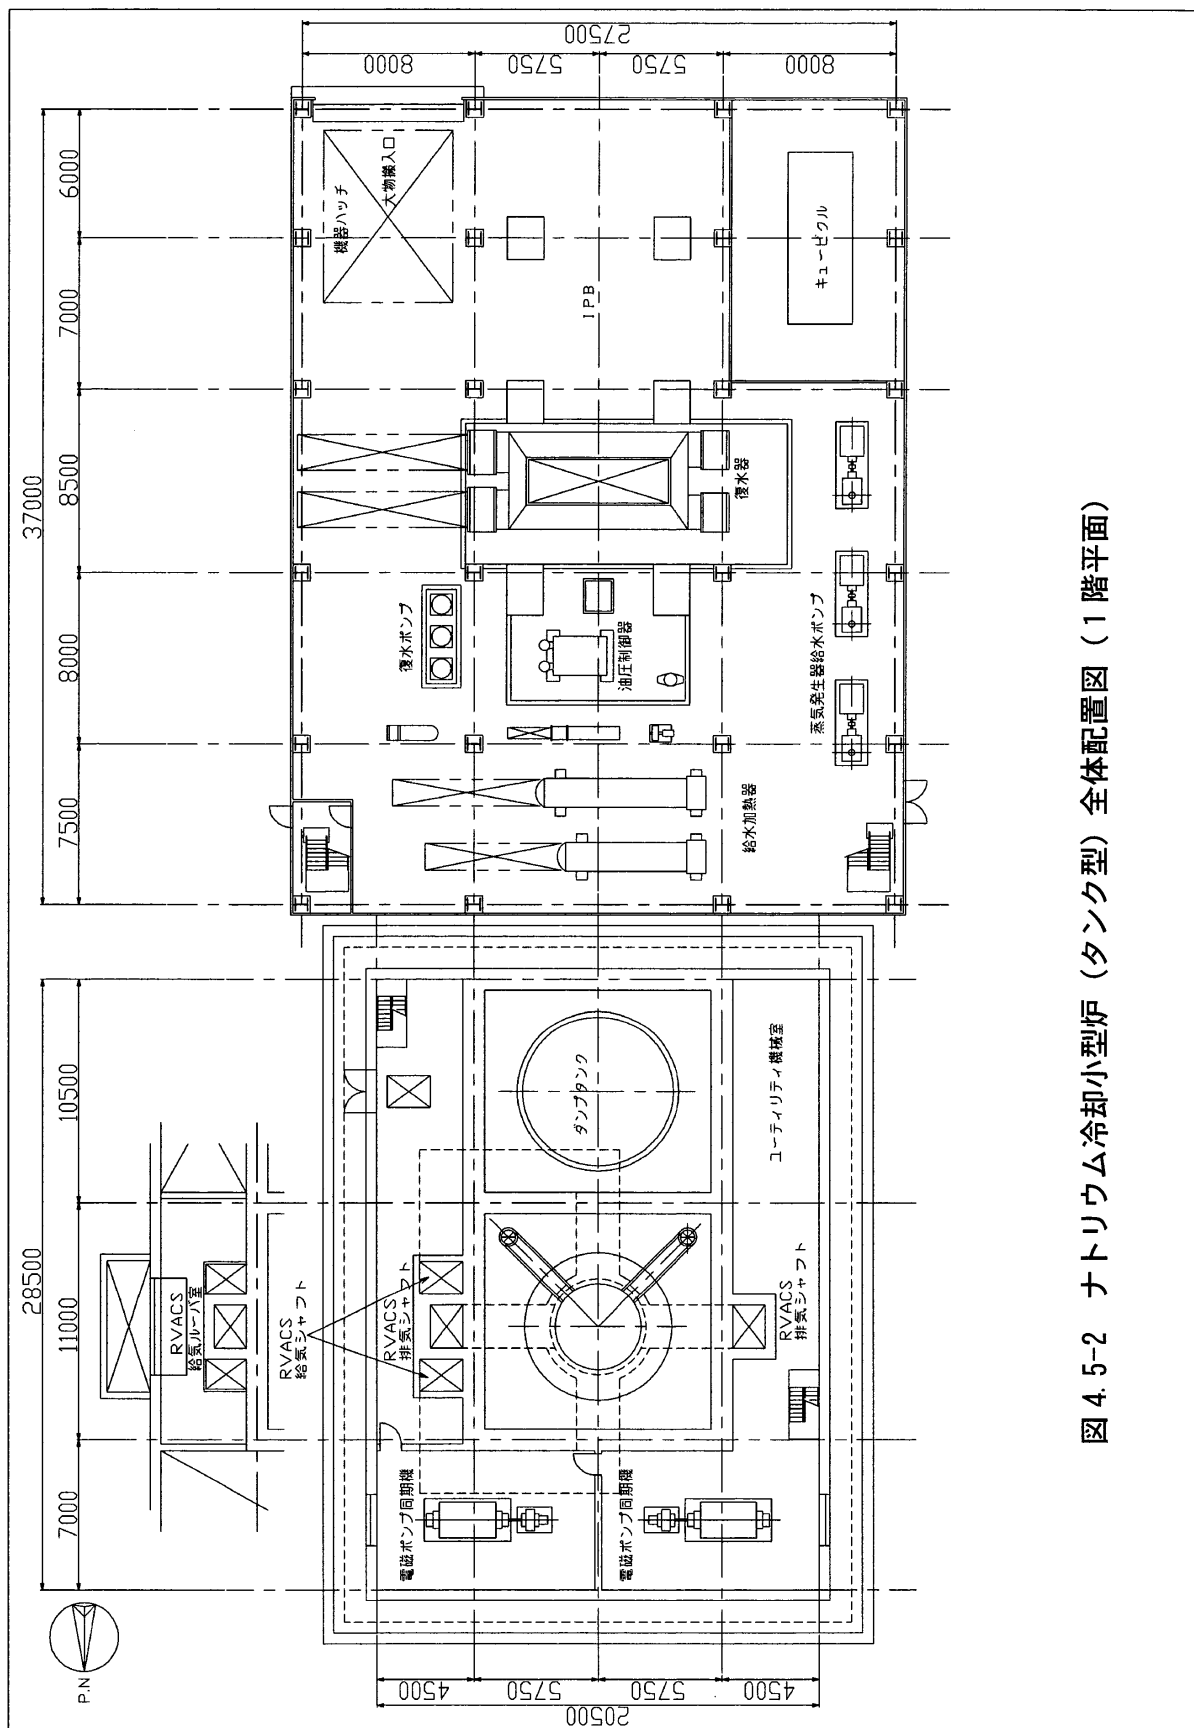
ナトリウム冷却小型炉 (タンク型) 全体配置図 (1 階平面)
